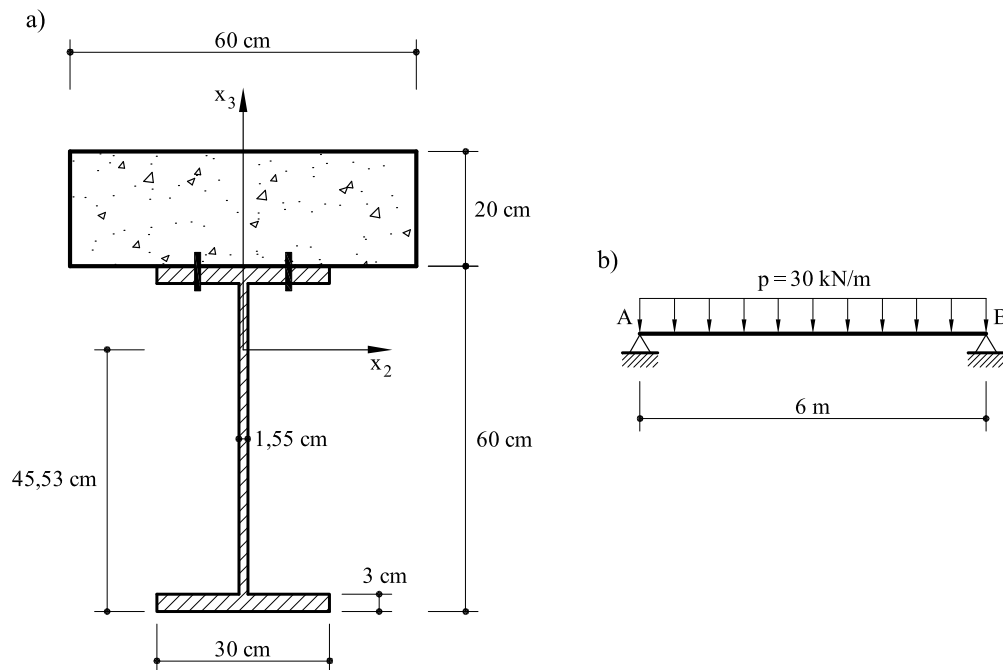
Viga y sección mixta correspondiente al problema 5.15
